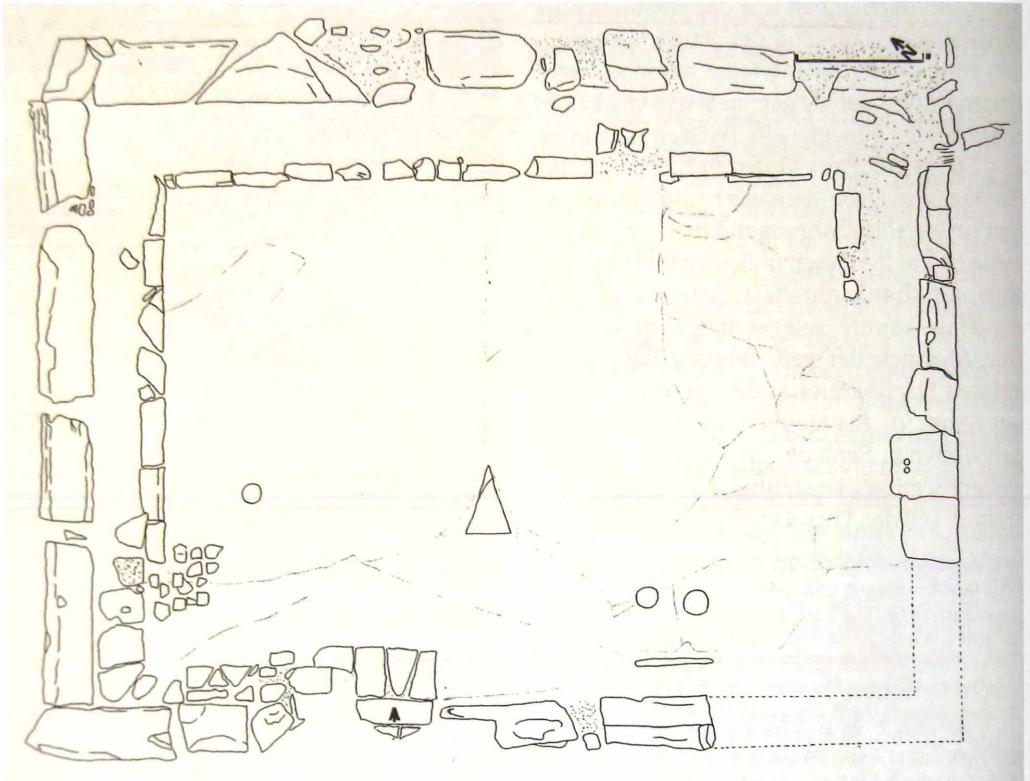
Umm Saysabân, Grundriss Haus 20 (Zeichnung von E. Schreyer 2012)
